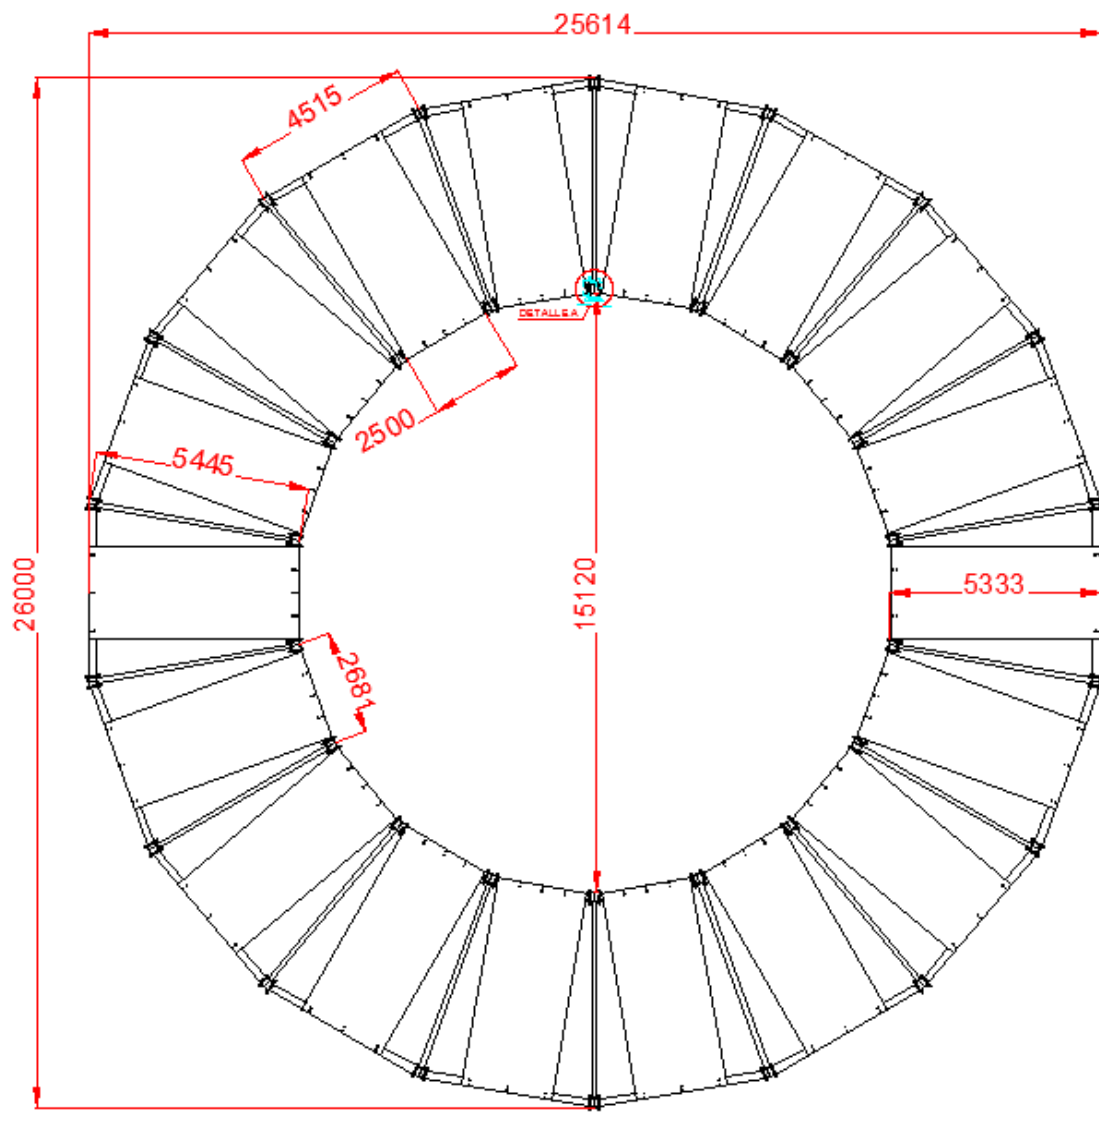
Distribución en planta de las plazas de aparcamiento.
